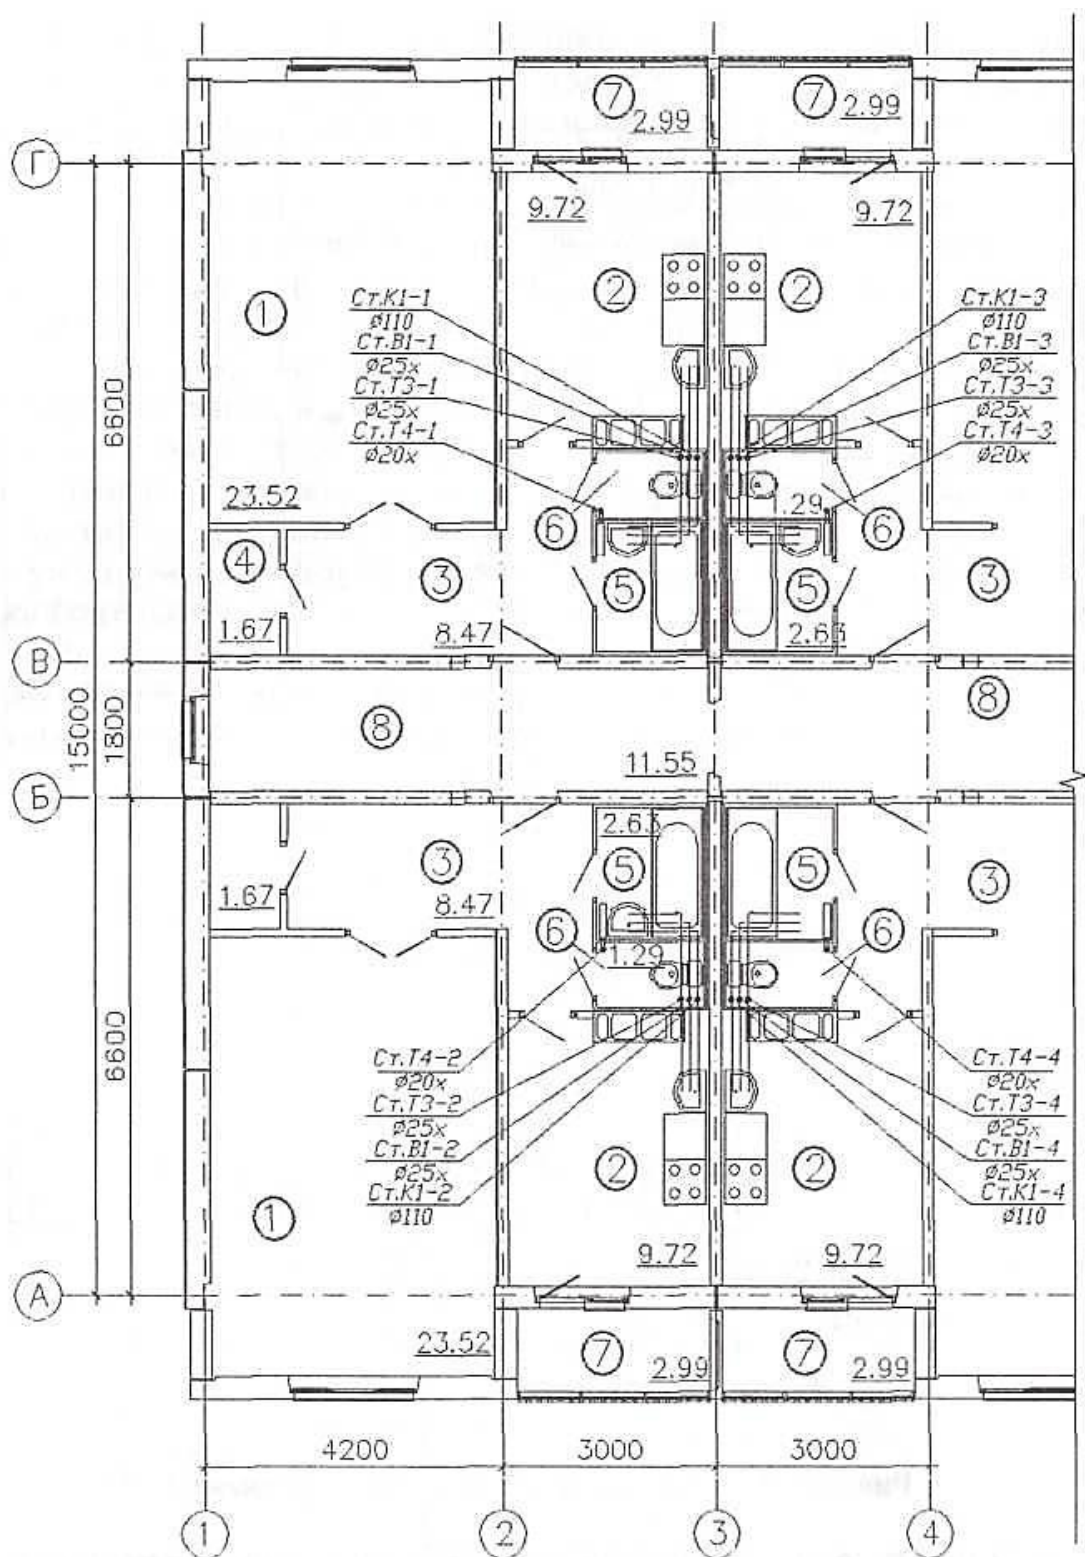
План типового этажа жилого дома (фрагмент)
